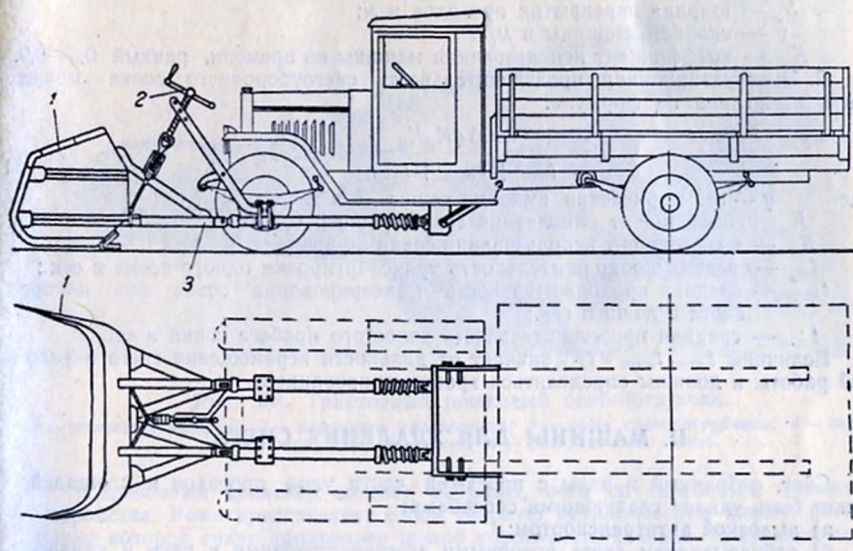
Схема автомобильного снегоборочного совка на шасси автомобиля ЗИС-5 с механическим приводом подъема ковша:
